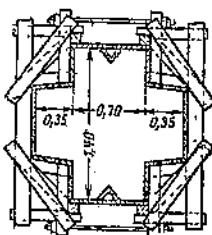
Конструкция опалубки колонн перемычки в Бекхольмен.
